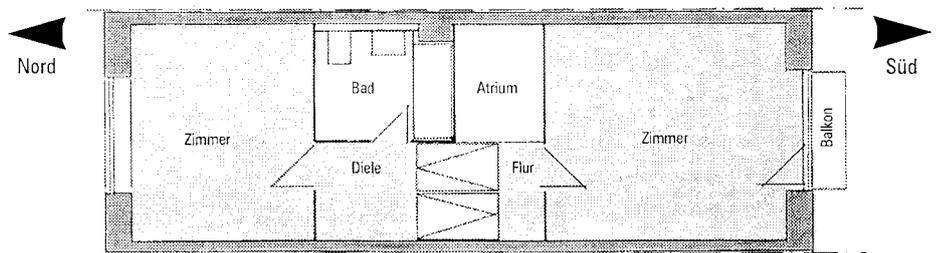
Grundriss OG eines Passiv-Reihenhauses
